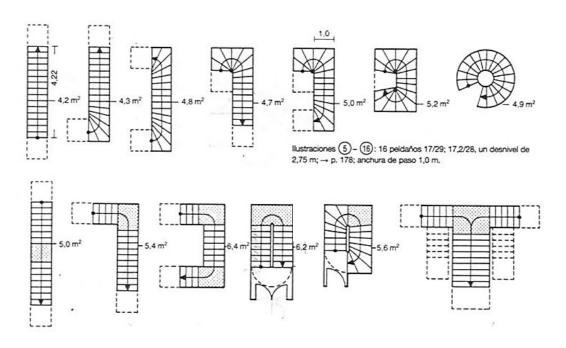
Tipos de Escaleras y Dimensiones para circulación.
